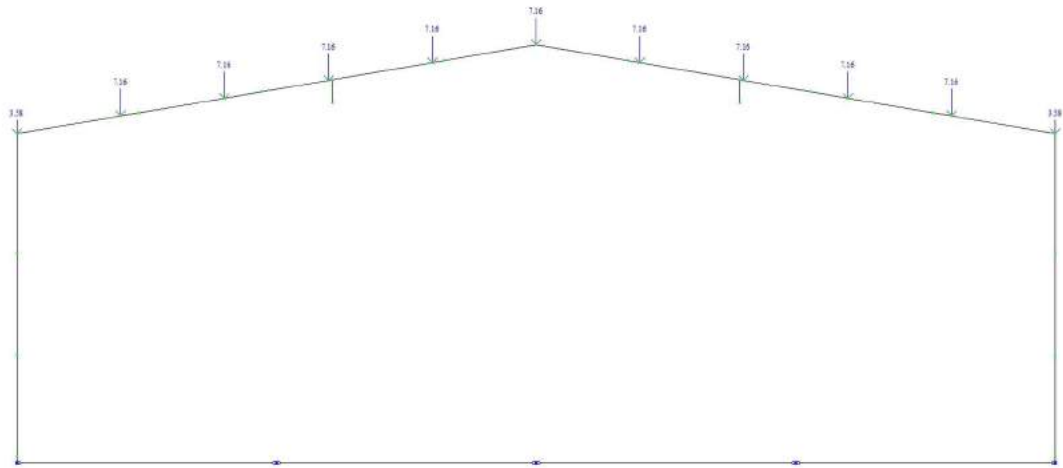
Собственный вес от покрытия и стенового оборудования.
